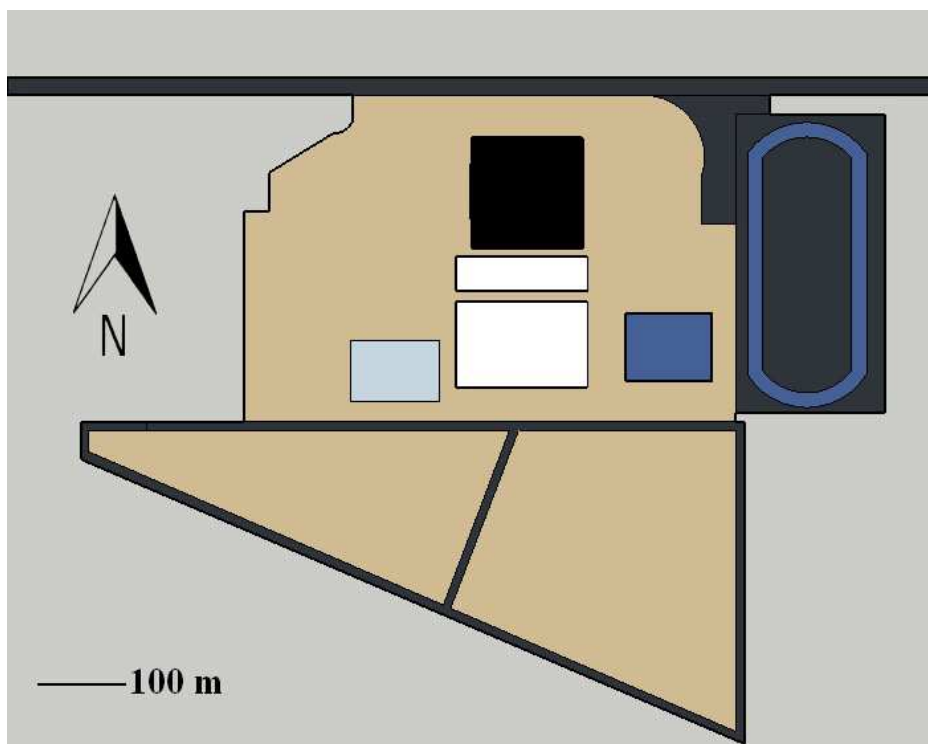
Plan de masse du Parc des expositions avec la nouvelle salle
